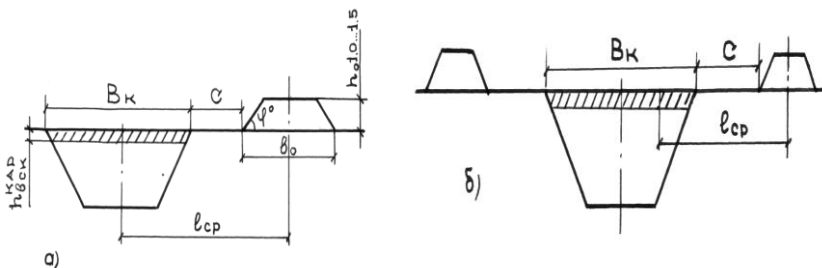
Схема к определению среднего расстояния перемещения грунта при вскрыши карьера с укладкой грунта: а – на одну сторону; б – на обе стороны
